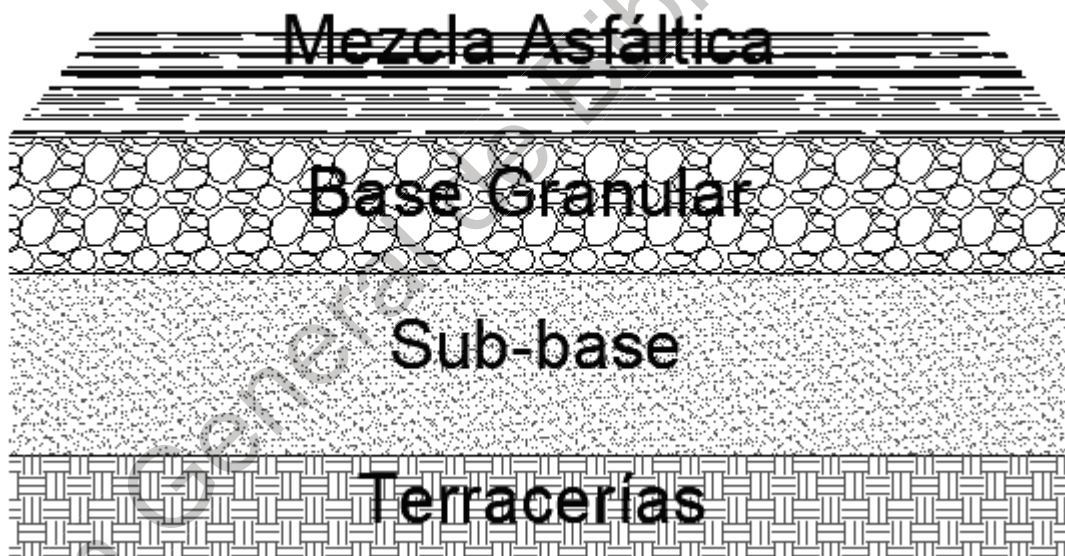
Estructura de pavimento flexible convencional (Zárate, 2011).
